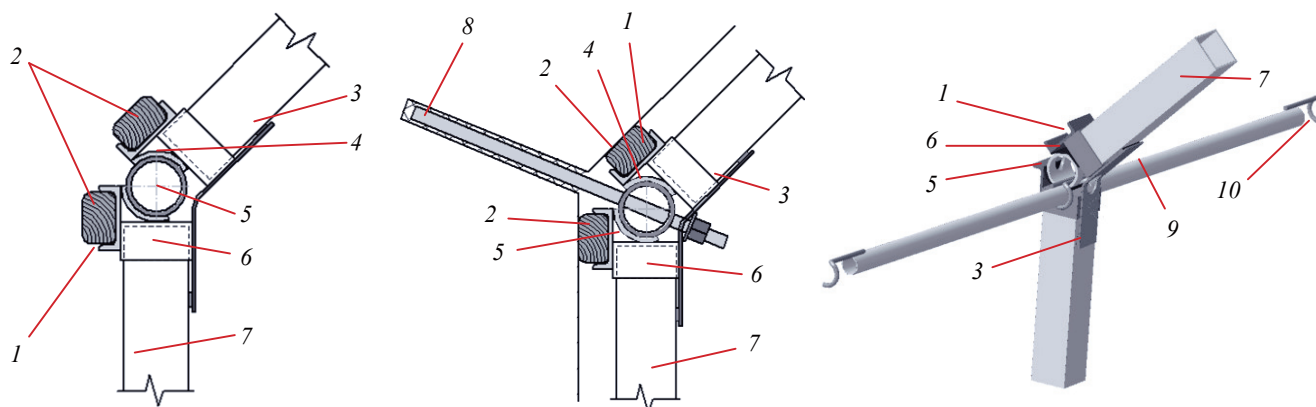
Шарнирный узел соединения несущих элементов крепи: 1 – отрезок швеллерной формы для установки расклинки; 2 и 4 – сегментная вставка; 3 – планка; 5 – труба-шарнир; 6 – обойма; 7 – несущий элемент крепи; 8 – анкер; 9 – межрамная стяжка; 10 – клиновой фиксатор.
